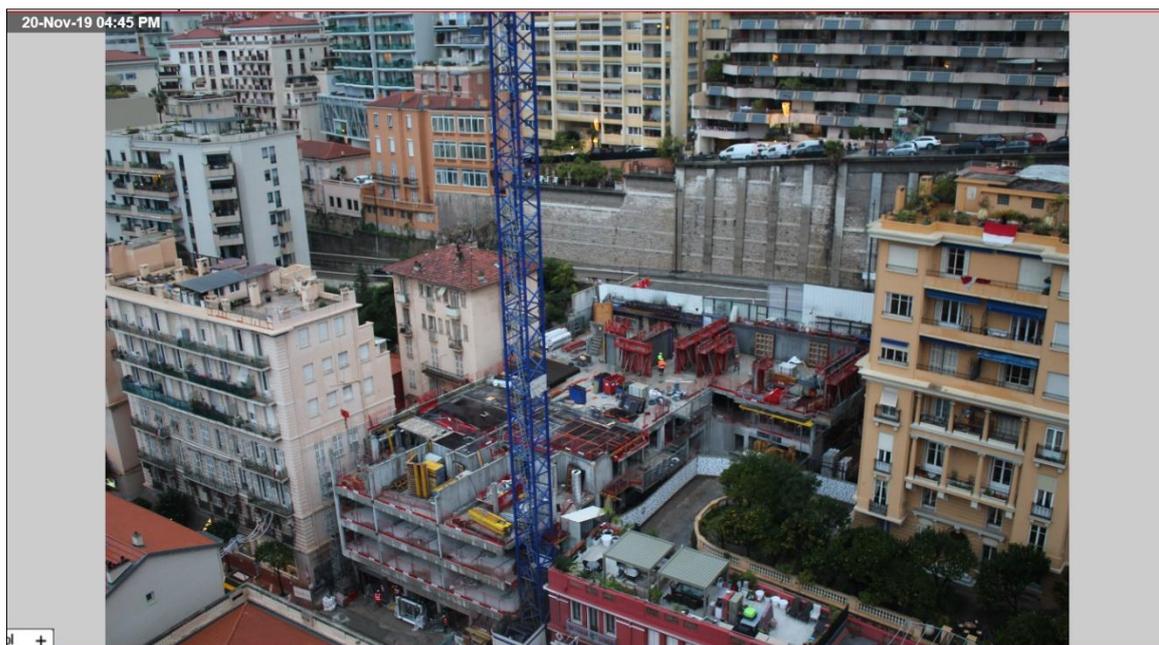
Fotografia del 20 novembre 2019 (ore 16:45) - Realizzazione Piano terzo e inizio piano quarto, fonte Vinci Construction Monaco
